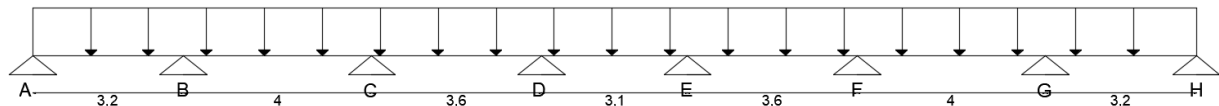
Schéma statique d'une poutre reposant sur 8 appuis à l'ELU
